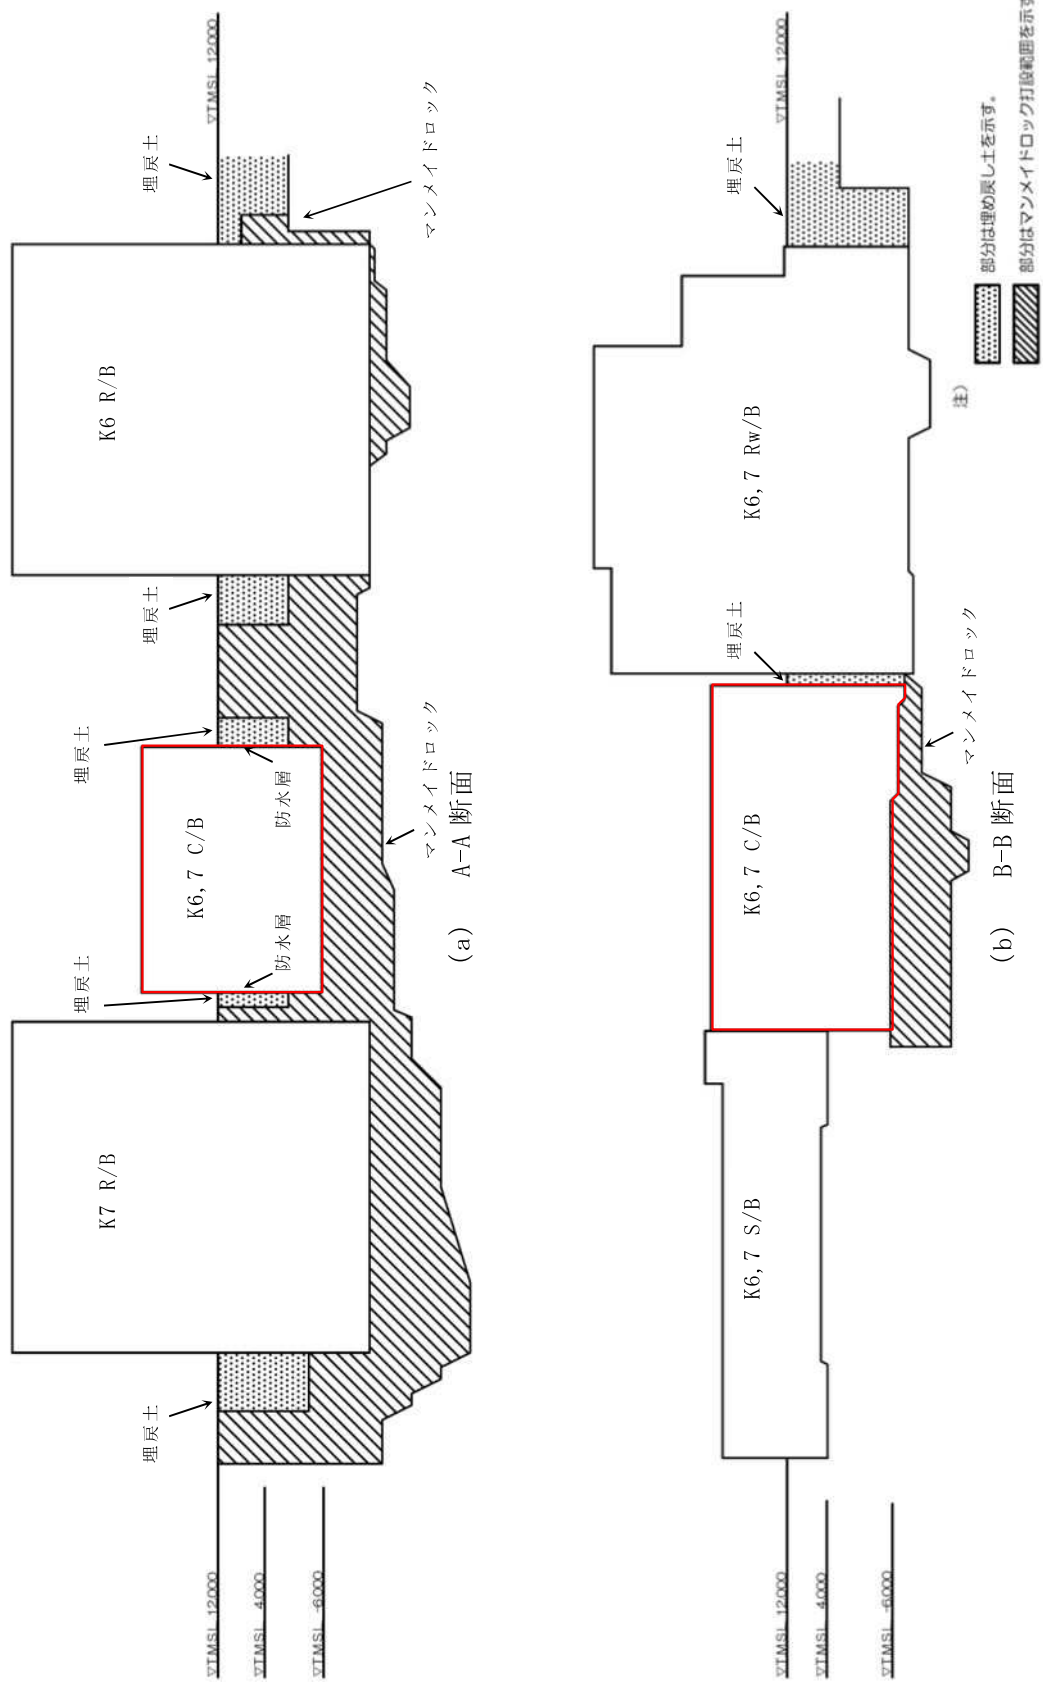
コントロール建屋の設置状況 (断面図) (単位: mm)
